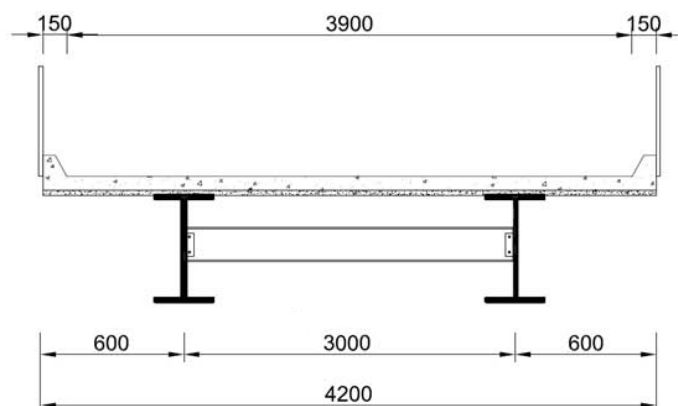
Detalhe do dimensional de uma ponte mista em pista simples conforme manual do DNIT, dimensões em mm.
